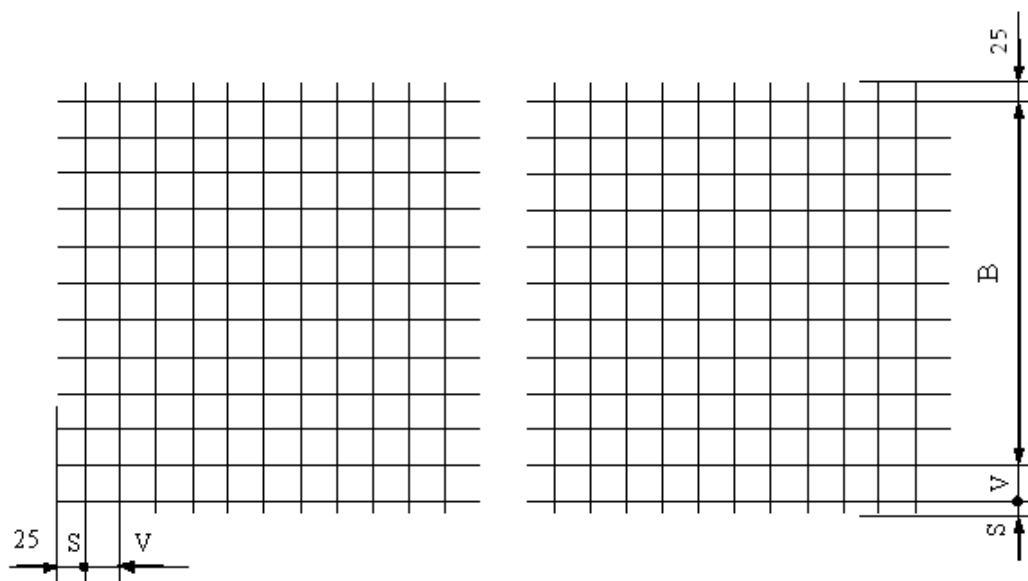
Сварная металлическая сетка, используемая в конструкциях из ненапряженного железобетона.
